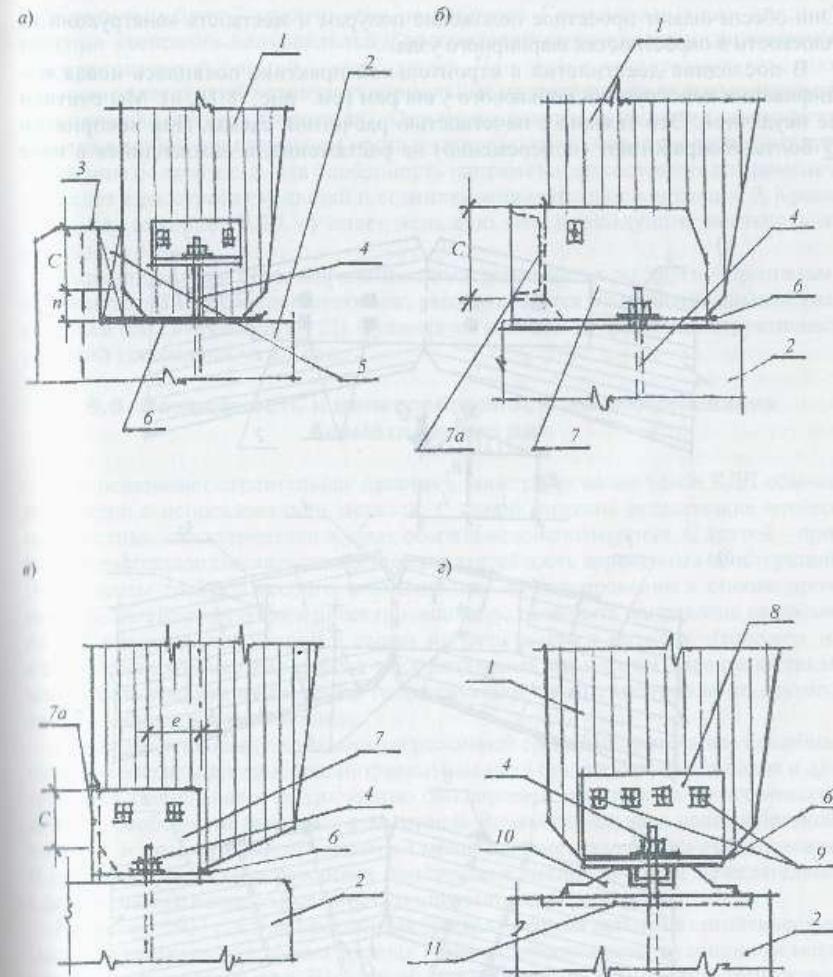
Опорные узлы рам: а – с передачей обеих составляющих опорной реакции на фундамент; б, в, г – с передачей распора на сварные башмаки; 1 – стойка рамы; 2 – фундамент; 3 – армированый выступ фундамента; 4 – анкерный болт; 5 – выравнивающая антисептированная прокладка; 6 – гидроизоляция; 7 – сварные башмаки с упорными столиками 7а; 8 – башмаки из листового материала с передачей распора через болты; 9 – горизонтальные расчетные болты; 10 – балансир шарнира; 11 – закладная деталь
